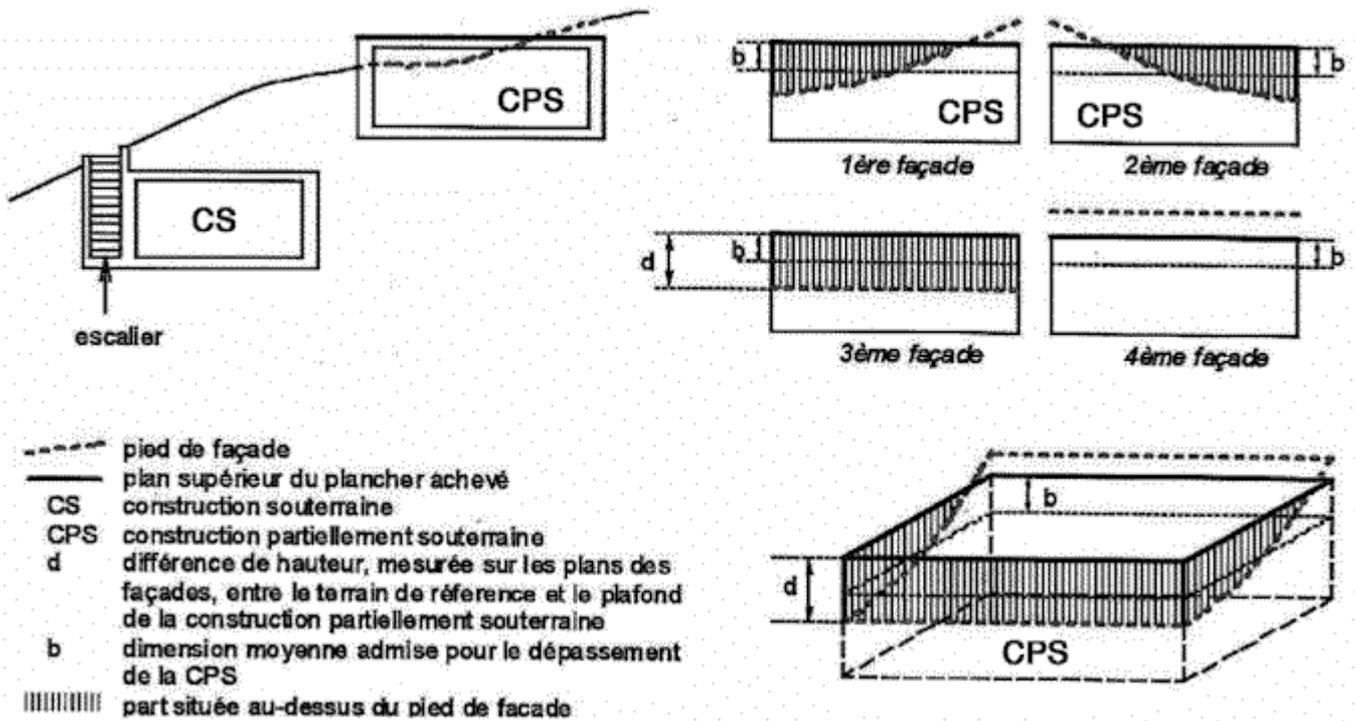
et 1.4 Constructions souterraines, constructions en sous-sol
